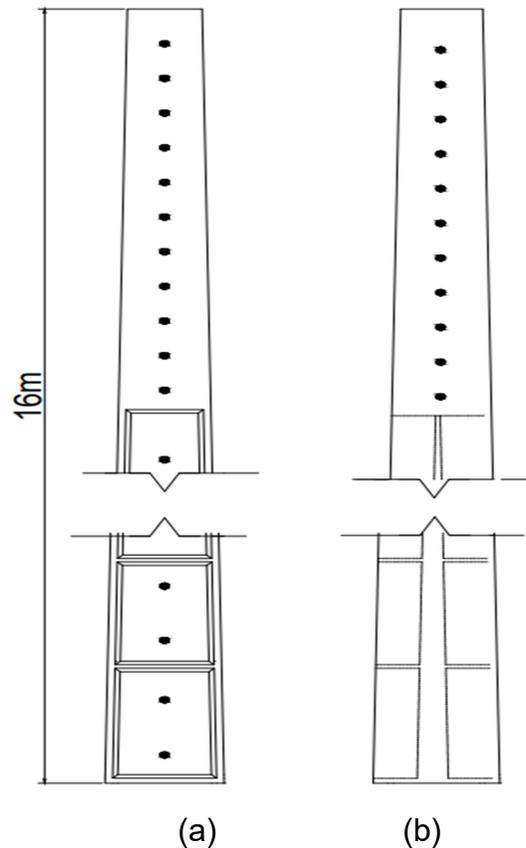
Poste de betão (a) vista frontal (b) vista lateral
